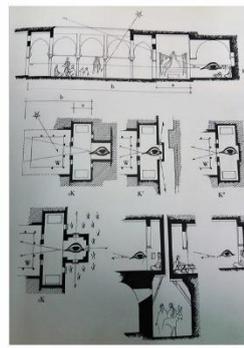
planche3 source : photos : Auteur. Ouvrage : André Raverau, et le site créa la ville.
